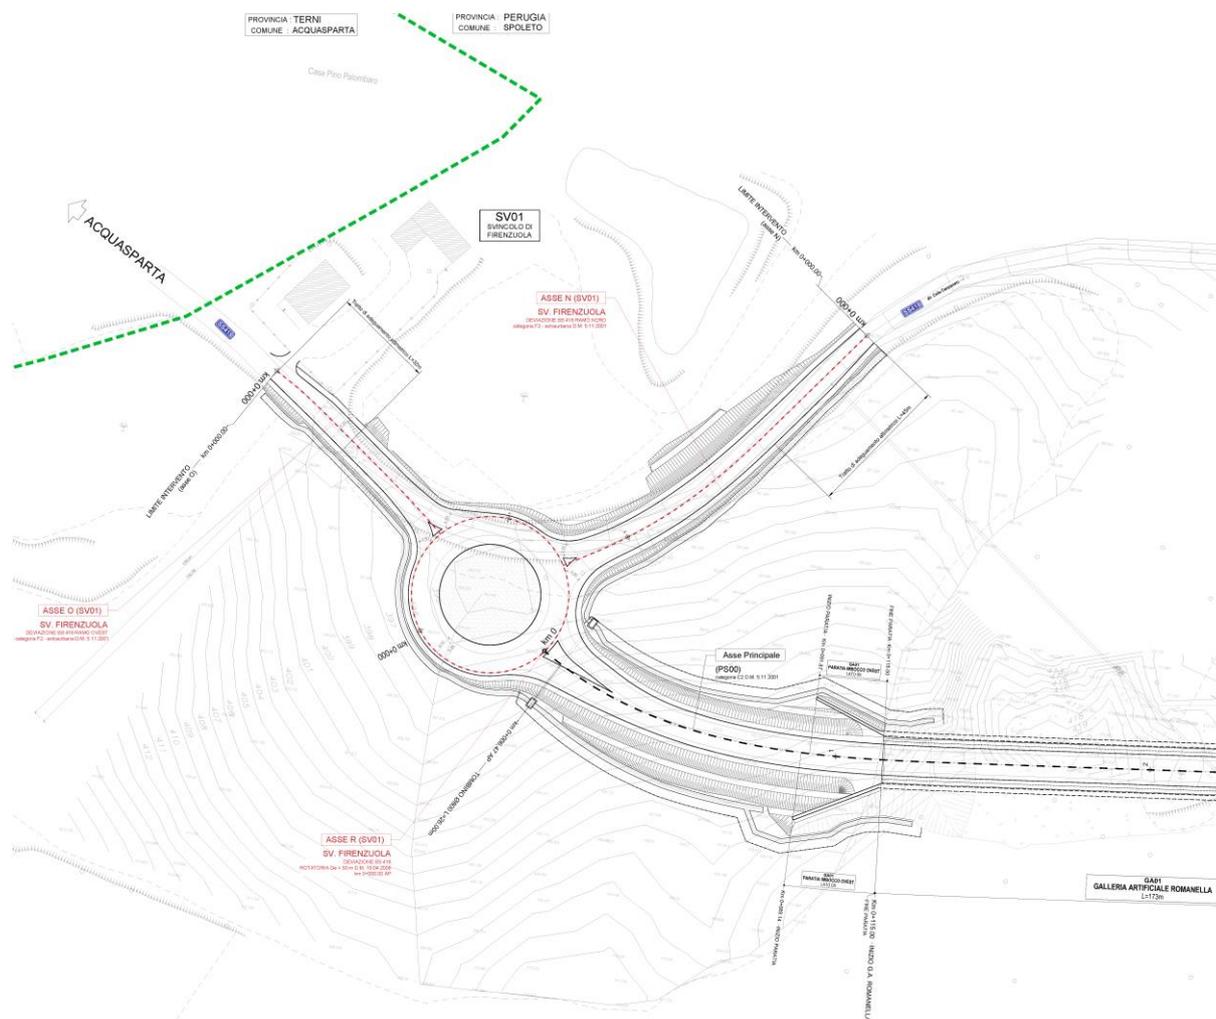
Svincolo di Firenzuola stralcio della planimetria di progetto
